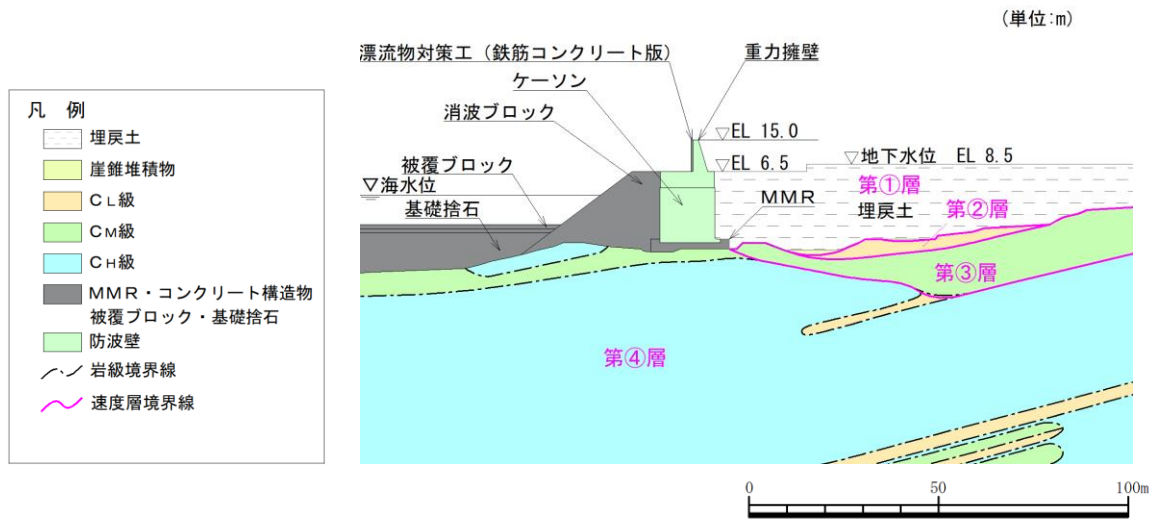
(1) 地質断面図 (防波壁 (波返重力擁壁) ①-①断面 (参考))
